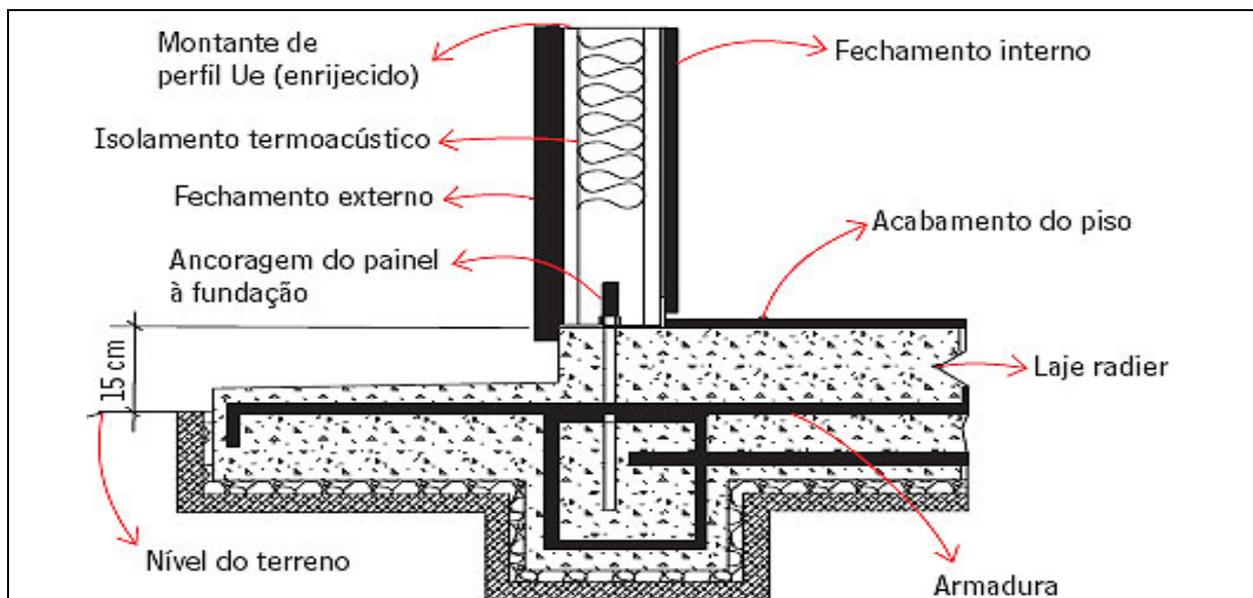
Estrutura em *Light Wood Frame* aplicada sobre *Radier*.
